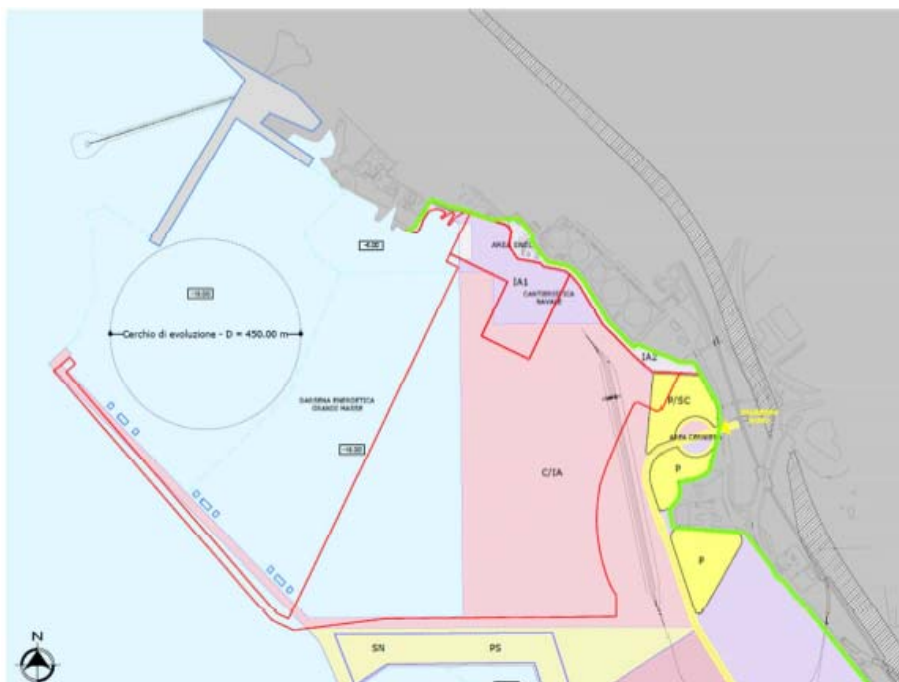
Planimetria di progetto: sovrapposizione nuova configurazione D.E.G.M. (linee rosse) su P.R.P. 2004.
